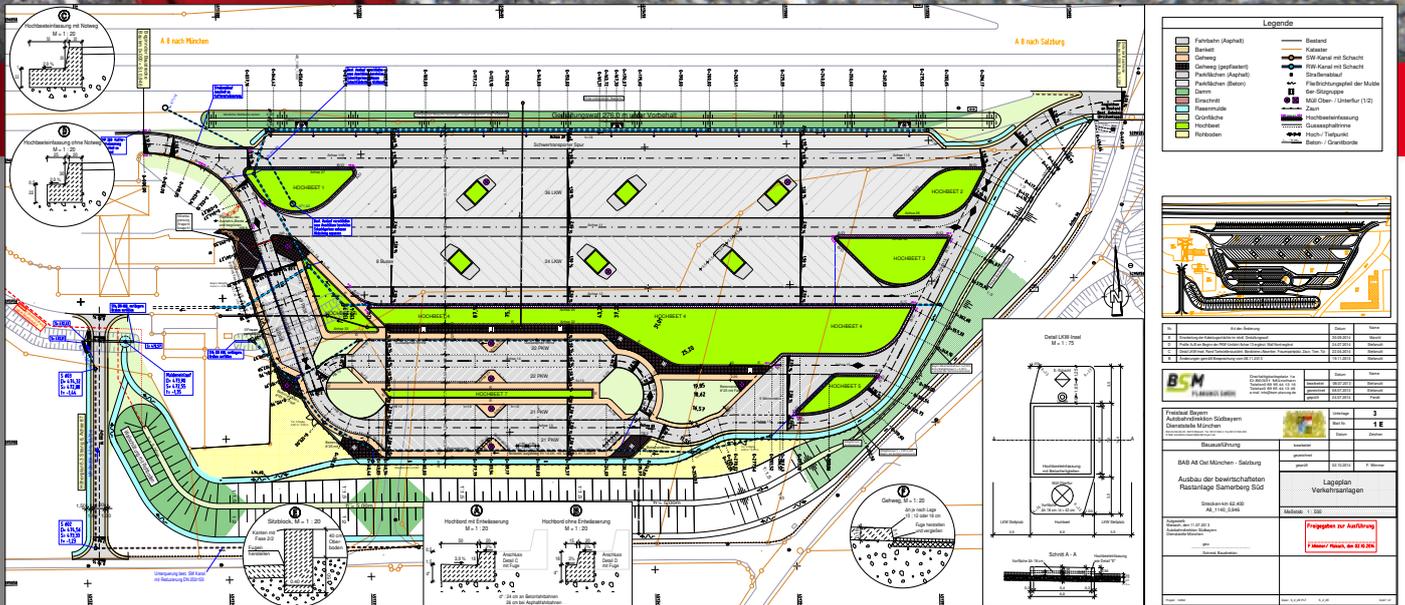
Ausführungsplan des ersten Bauabschnitts des Parkplatzes zur Tank- und Rastanlage.
